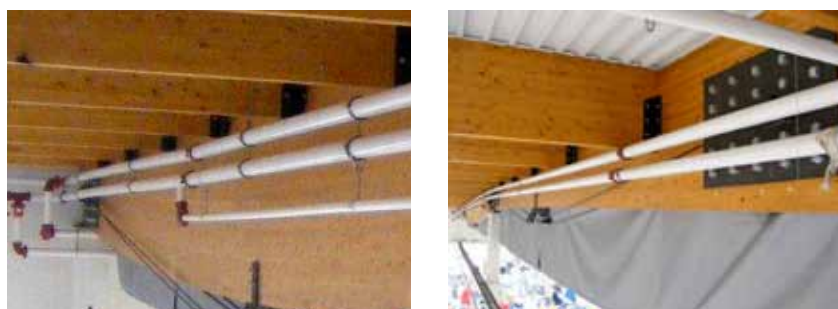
Imagen del refuerzo por cables de tesado viga extremo y viga central.
